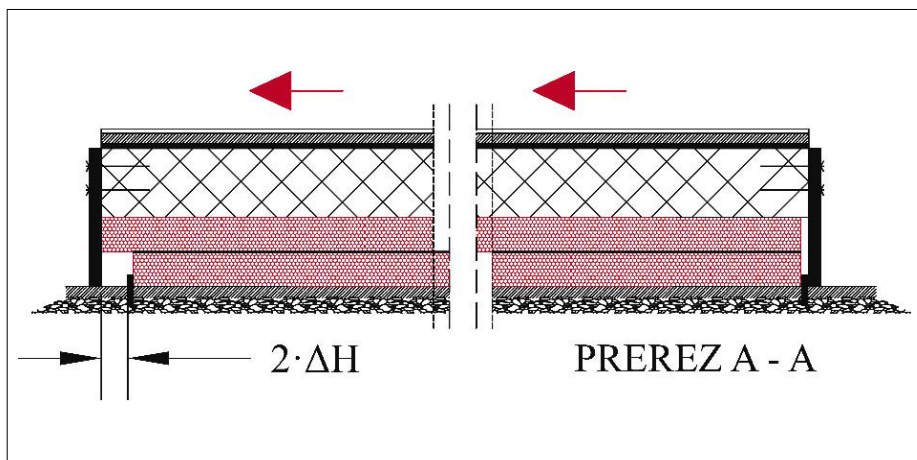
• Shematski prikaz (tloris in detajl) predlaganega sistema temeljenja
